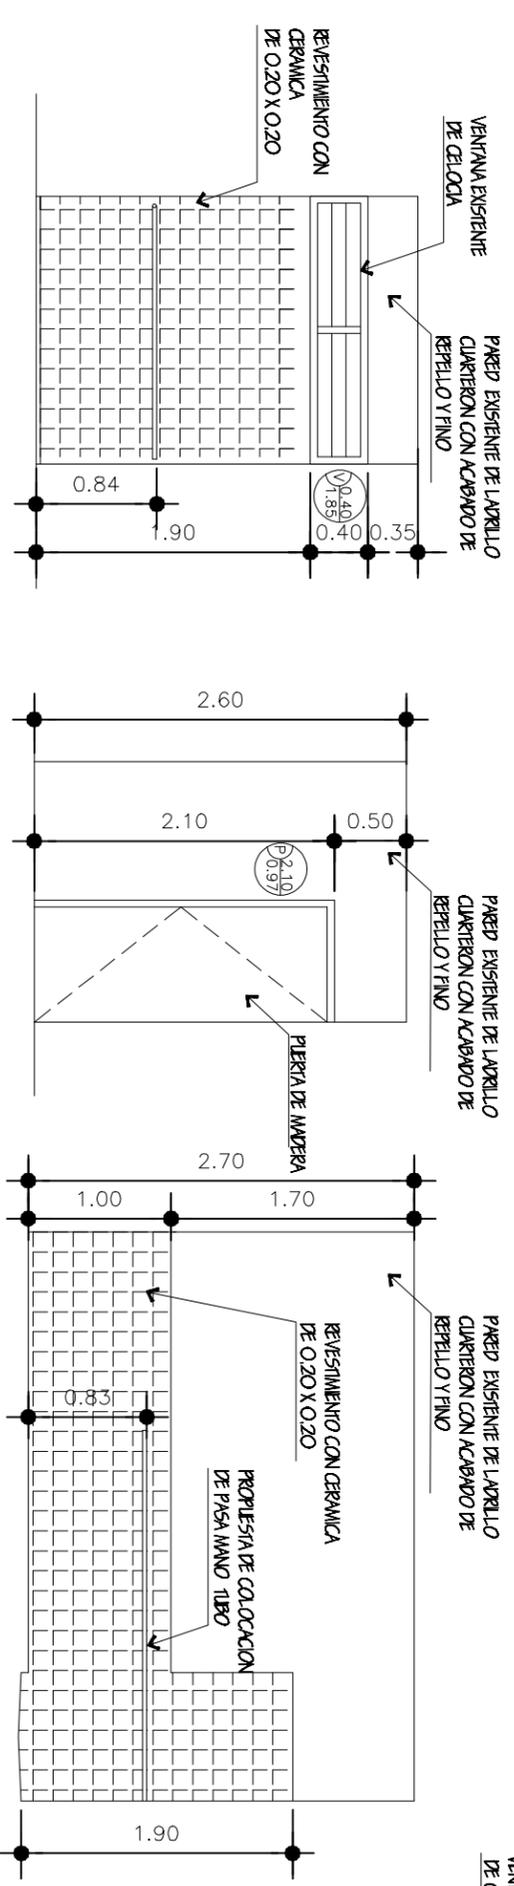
Planta de servicio sanitario Propuesto./ Fuente: Propia
